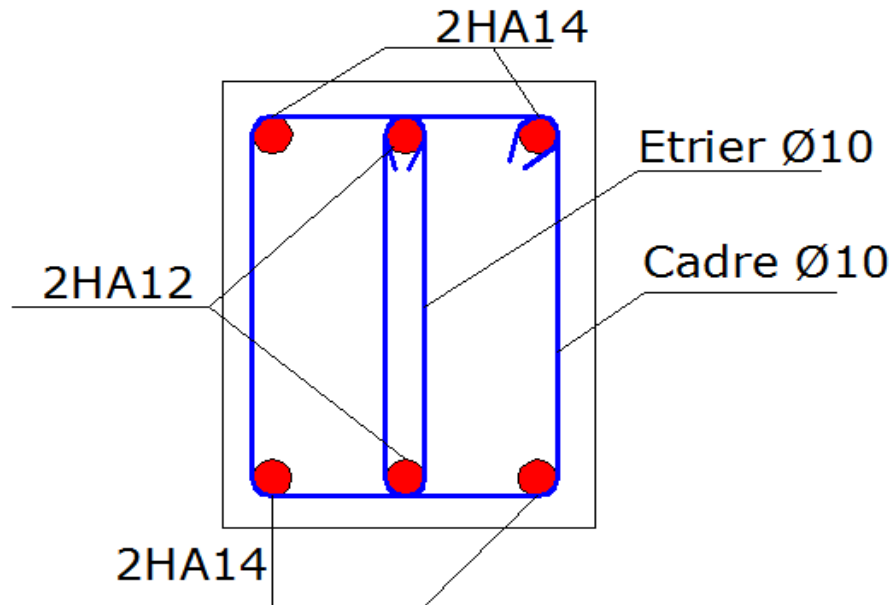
Schéma de ferraillage des poutres principales en travées et aux appuis
